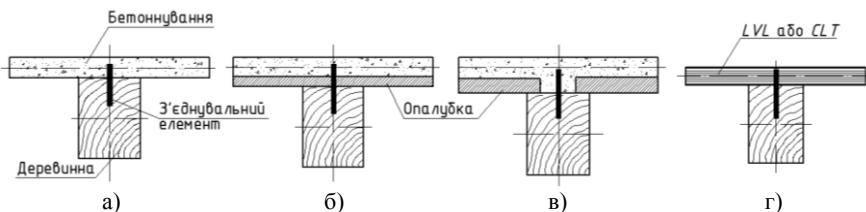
Типові поперечні перерізи дерев'яно-бетонних композитних плит
